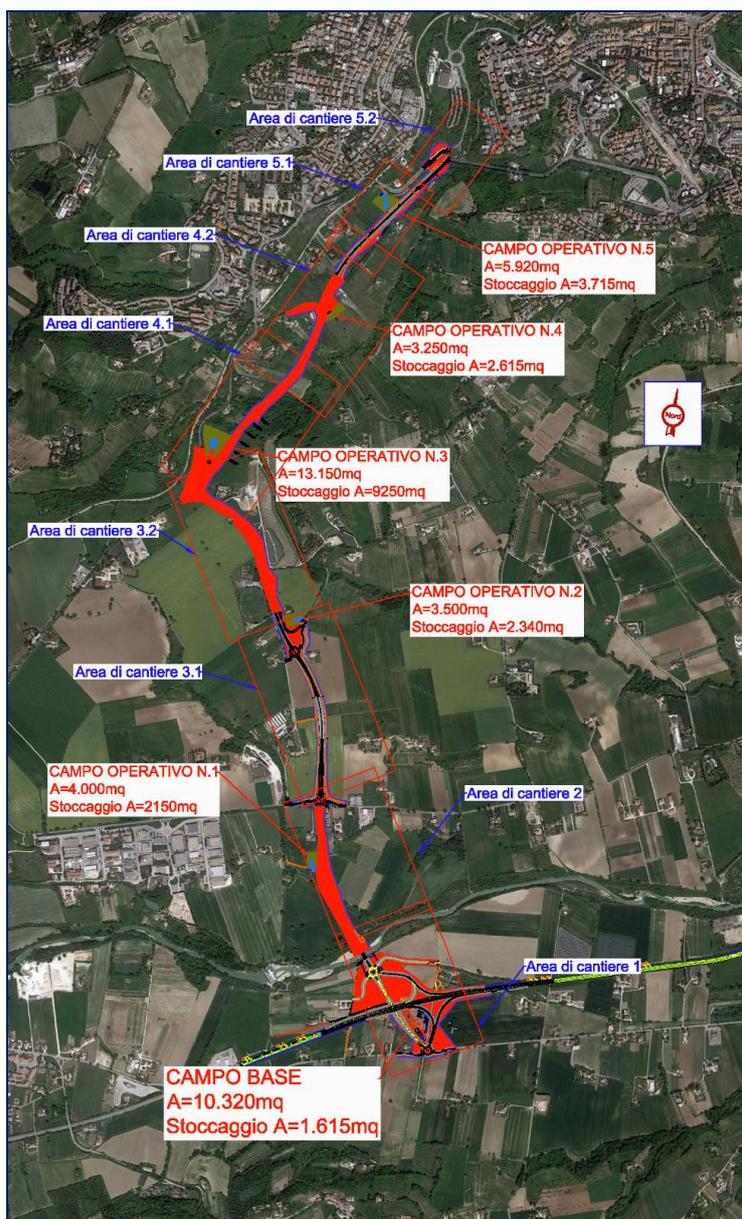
Inquadramento generale con individuazione delle aree di cantiere.
